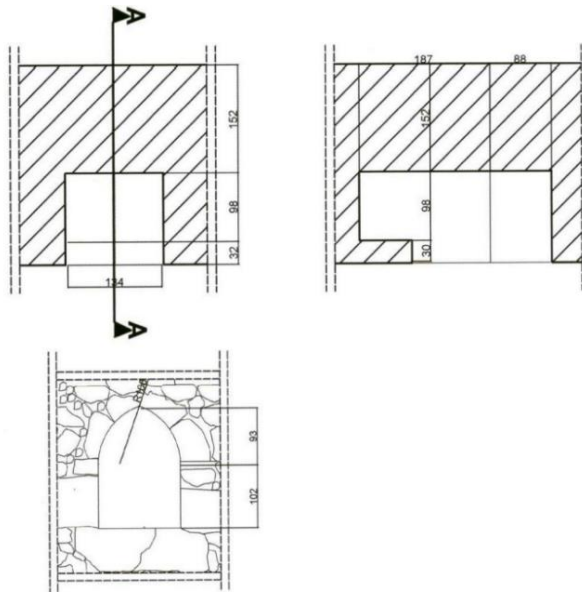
Pencere Plan-Kesit-Görünüş Detay Restorasyonu [79]
